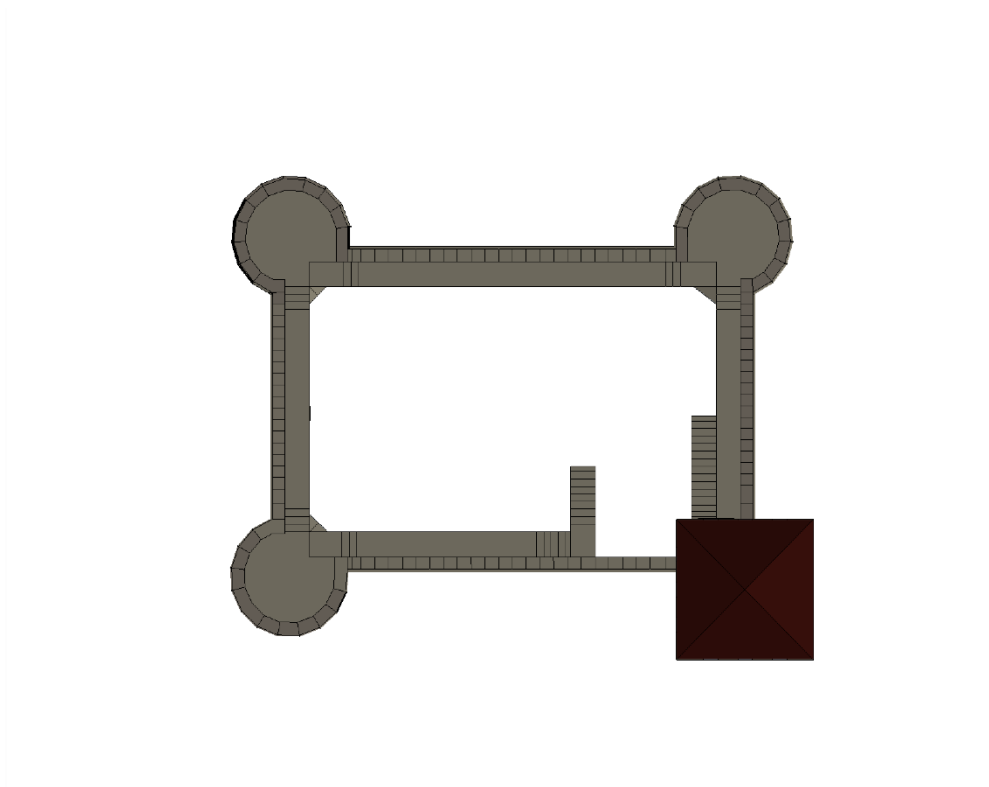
Proposta de planta do Castelo de Vimioso. Layouts model. © Ricardo M Dias
